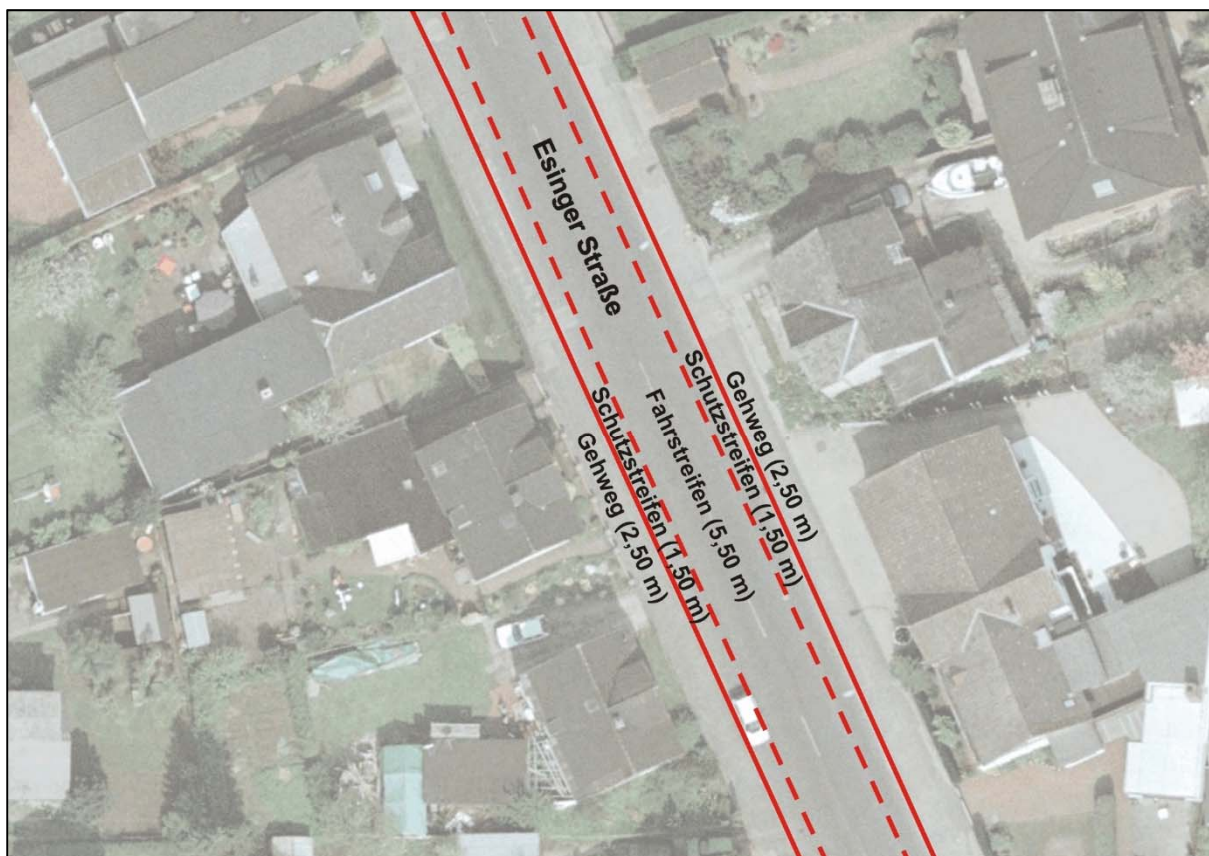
Radverkehrsführung Esinger Straße (M 16)
